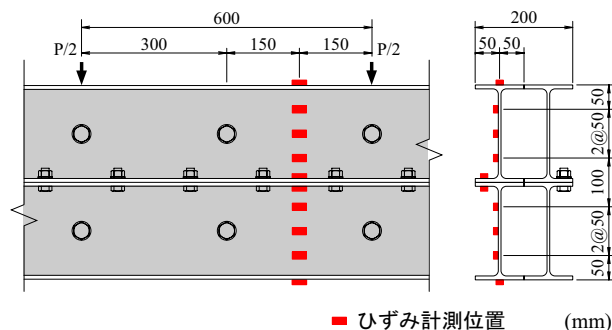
には、試験体の側面図および断面図を示している。本実験では、載荷装置の性能と試験体耐力を考慮し、断面寸法 200 × 100 × 5.5 × 8 の一般構造用圧延 H 形鋼 (SS400 材) 4 本を組み合わせ、桁高 400 mm、フランジ 200 mm、純スパン 4,800 mm の試験体を製作した。充填コンクリートについては、試験体の内空
